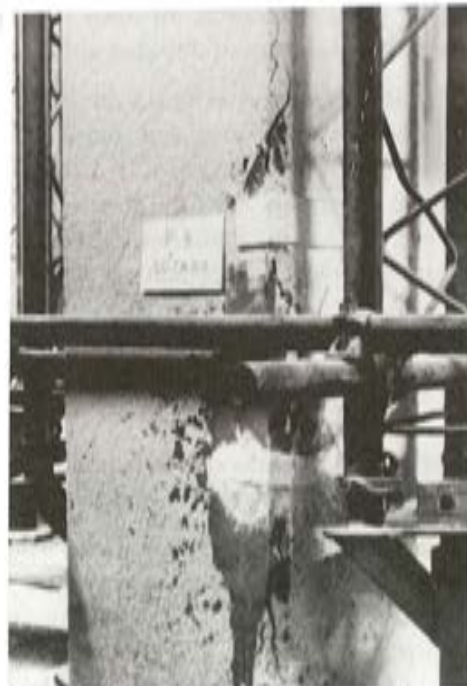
Esta fotografía corresponde al aspecto exterior que tenían algunos pilares de la mencionada obra y en los que todavía no se había quitado el enlucido. Se pueden observar las grietas exteriores debidas a la expansión de la armadura.
